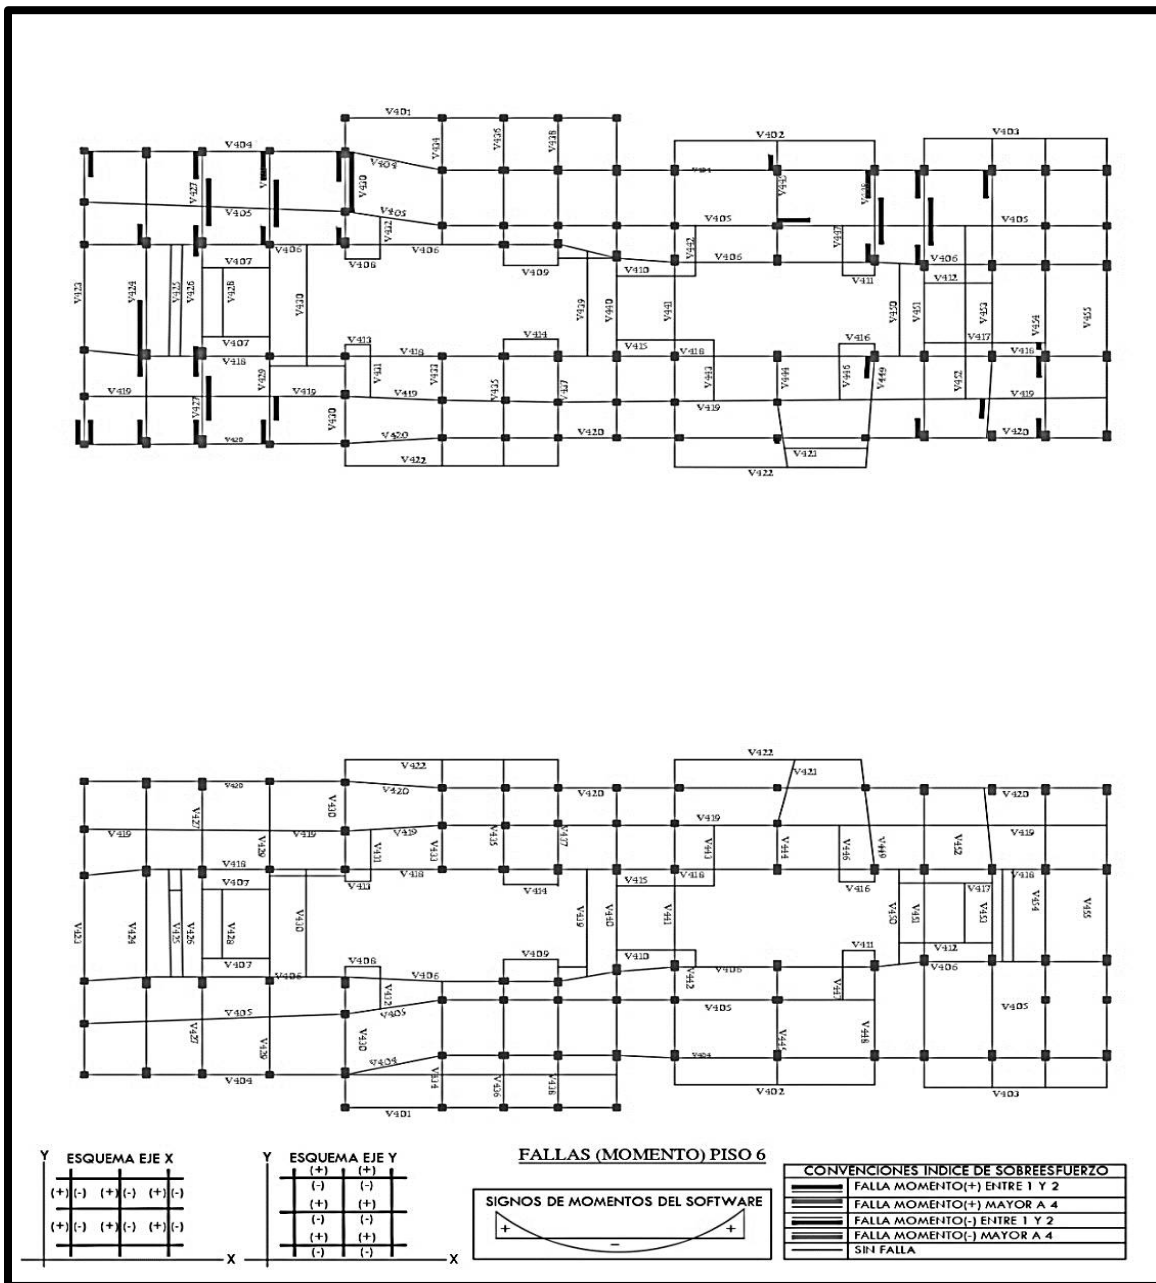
Plano de secuencia de fallas (momento) piso 6. Fuente: Los autores
